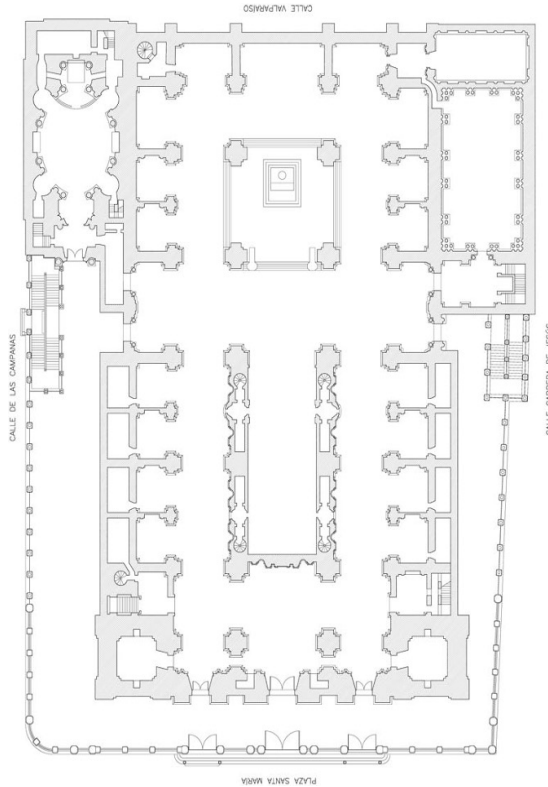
Planta actual de la catedral de Jaén. Imagen de Pedro Salmerón.
